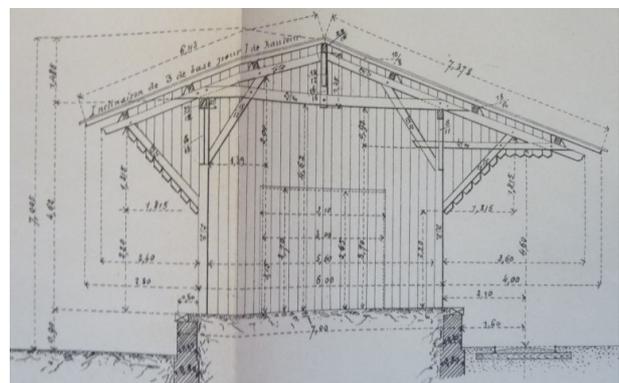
Sezione e prospetti di una Halle Marchandise. Figura _29_ Sezione di una Halle Marchandise.
